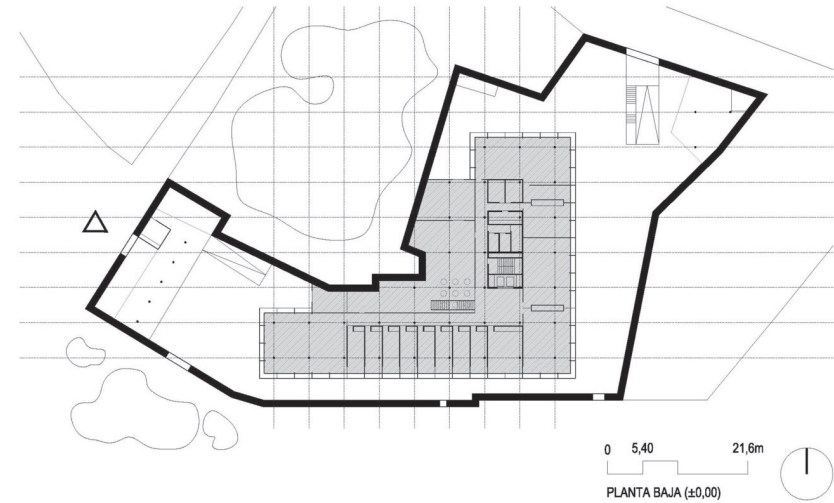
Planta Baja (Alberto Campo Baeza, 2012)
